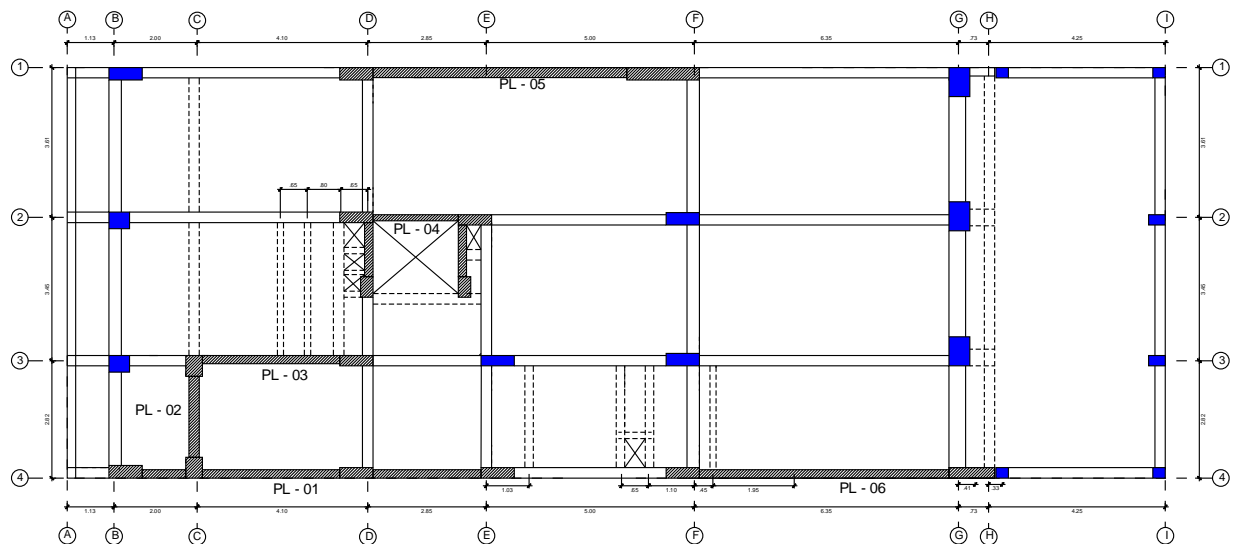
Vista de los elementos estructurales para el metrado del primer piso en el Palacio Municipal de San Miguel
